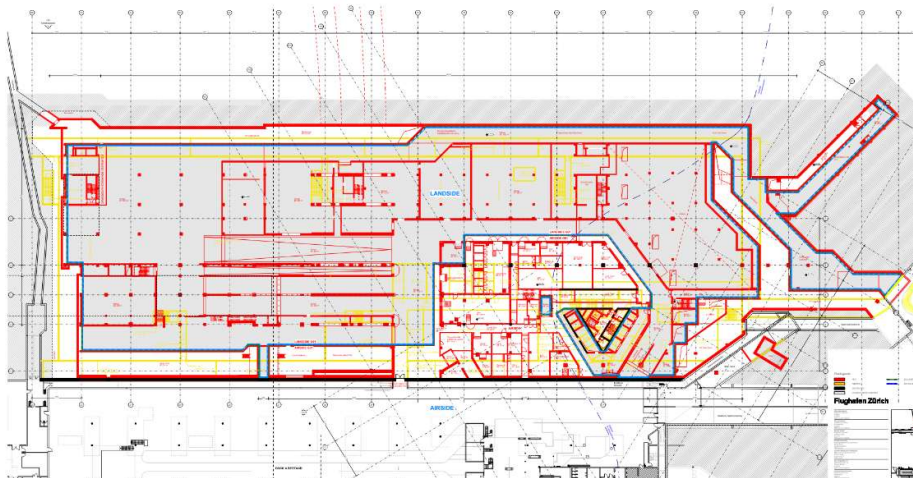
Aktualisierter Grundriss Untergeschoss G01
